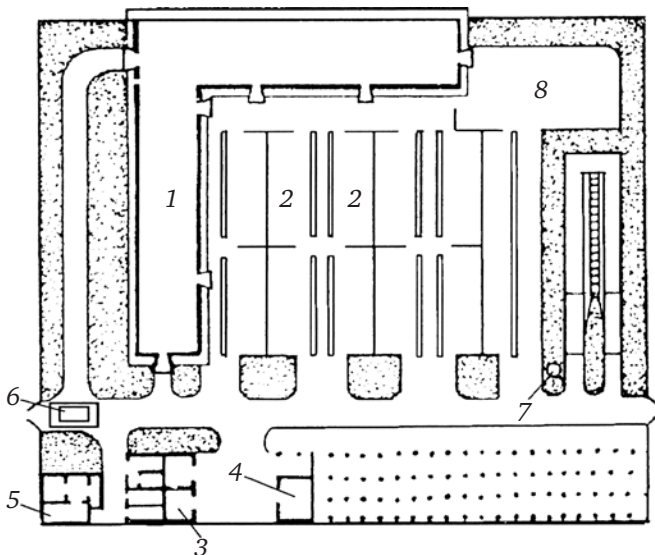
Генеральный план овцеводческой фермы на 600 маток:
